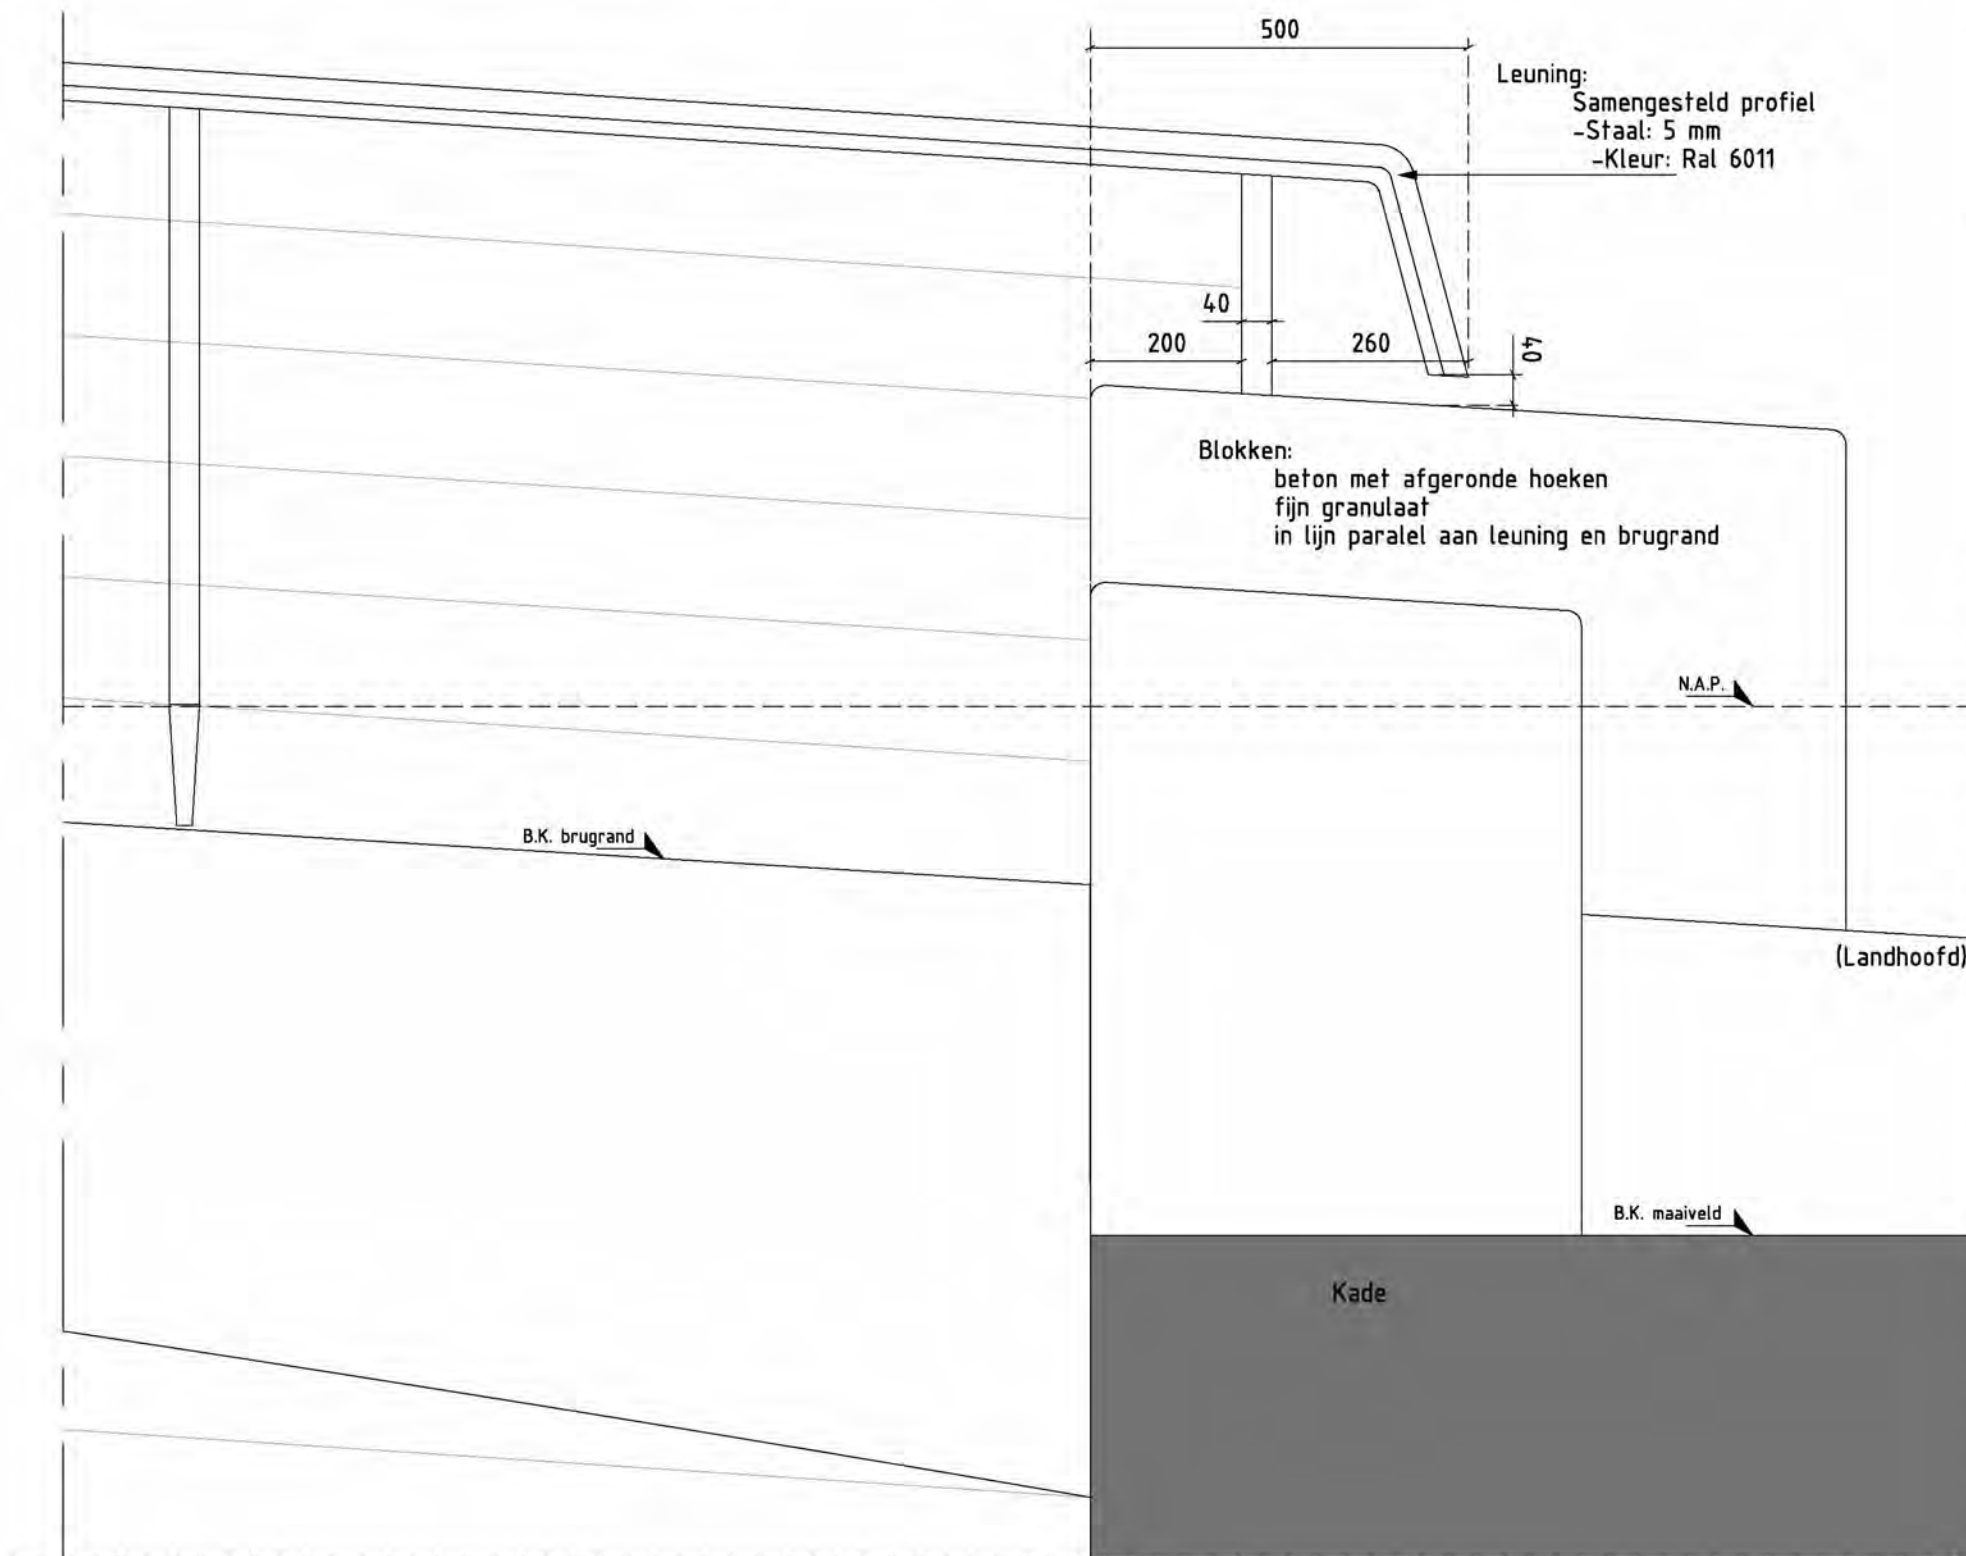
# DETAILS - brugleuning A-01 - handrail en blok CNW-zijde
